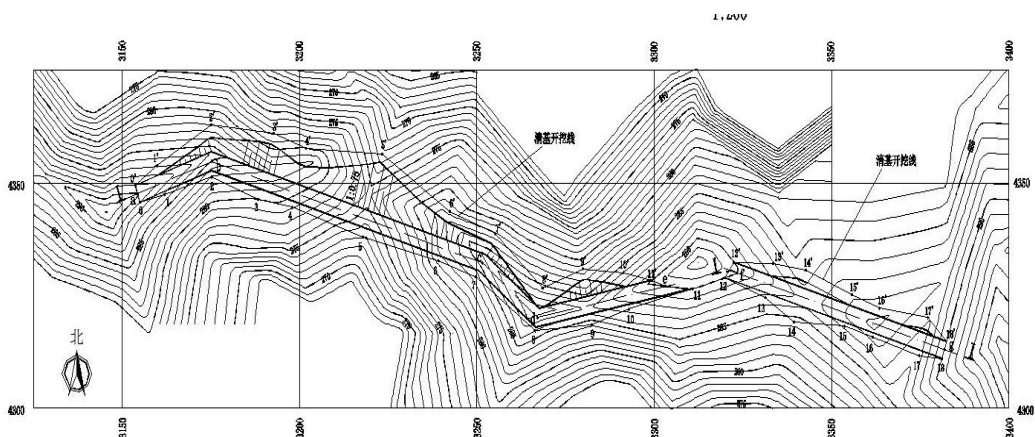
白枣峪尾矿库加高设计北副坝平面图
